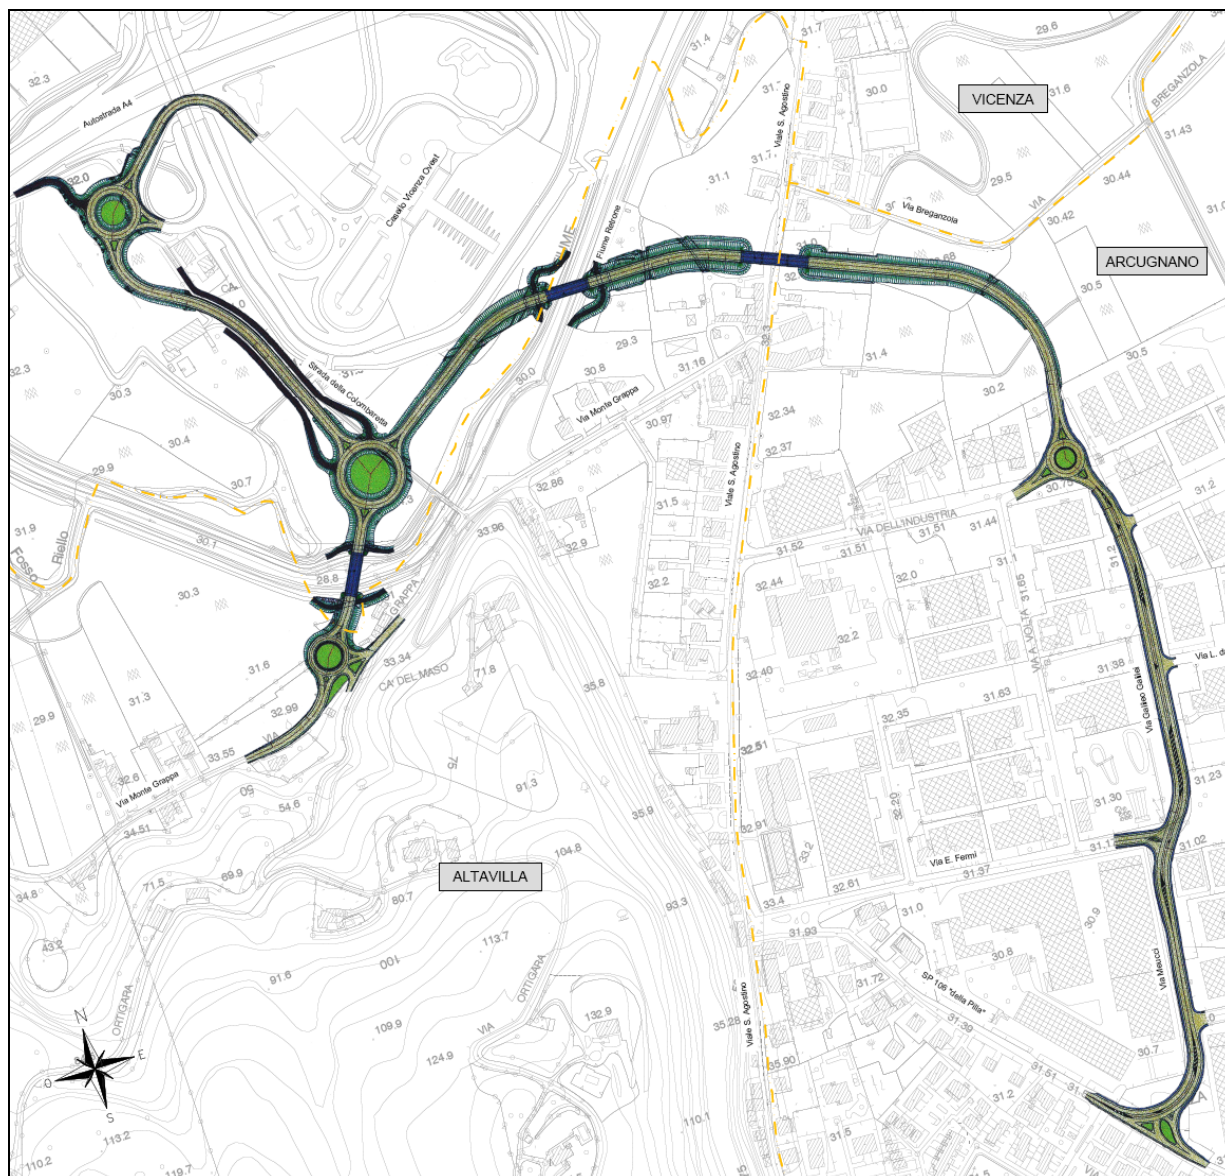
Planimetria della soluzione a base di gara (2004)
